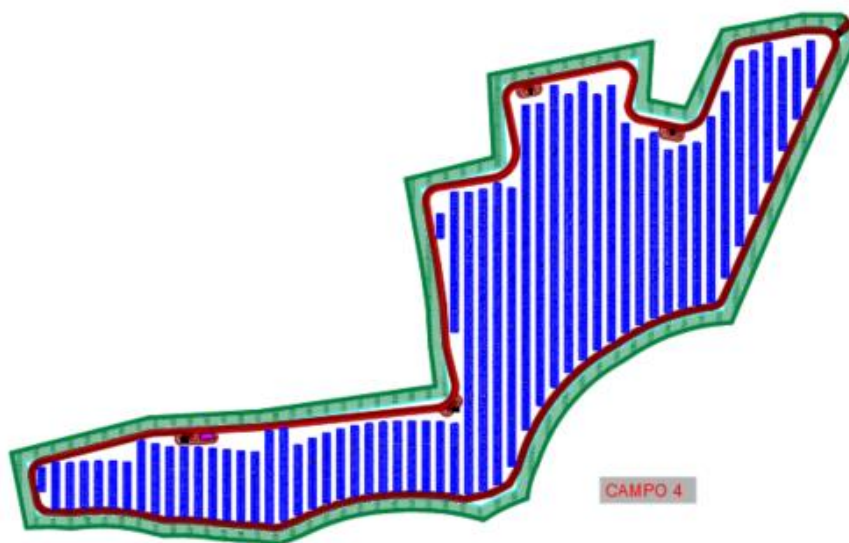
Schema di layout dell'impianto agrovoltaico: Campo 4
